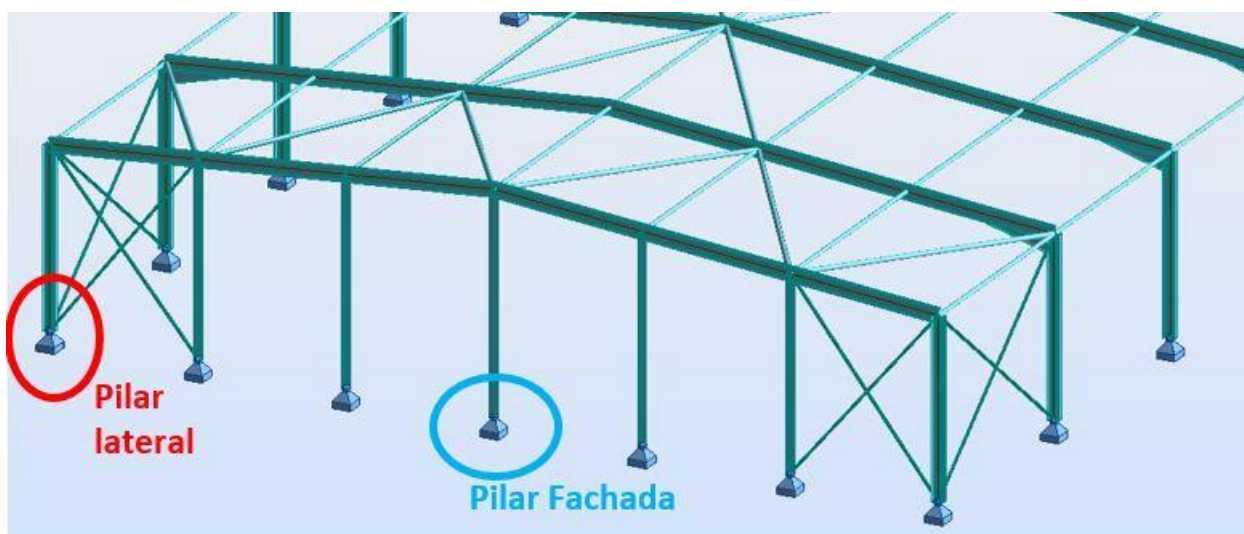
Localização das ligações entre pilares e fundações para pilares laterais e de fachada
